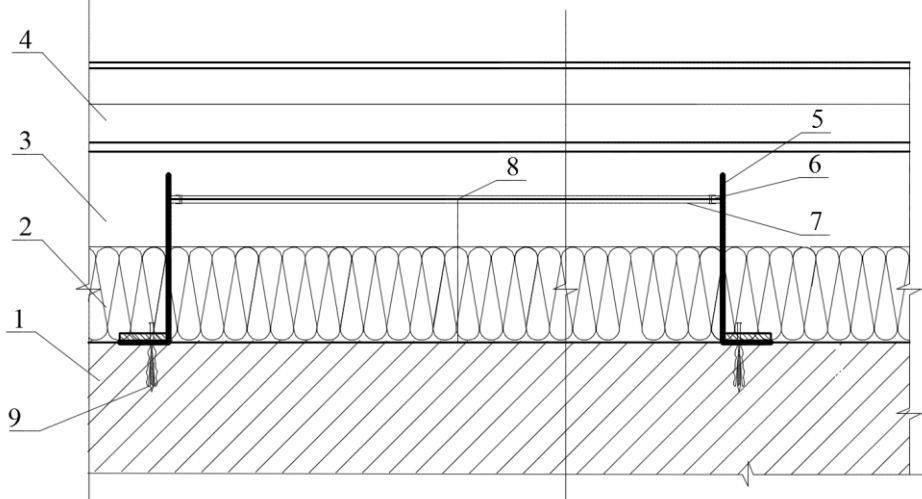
Противопожарная рассечка в конструкции НВФ вид сверху
